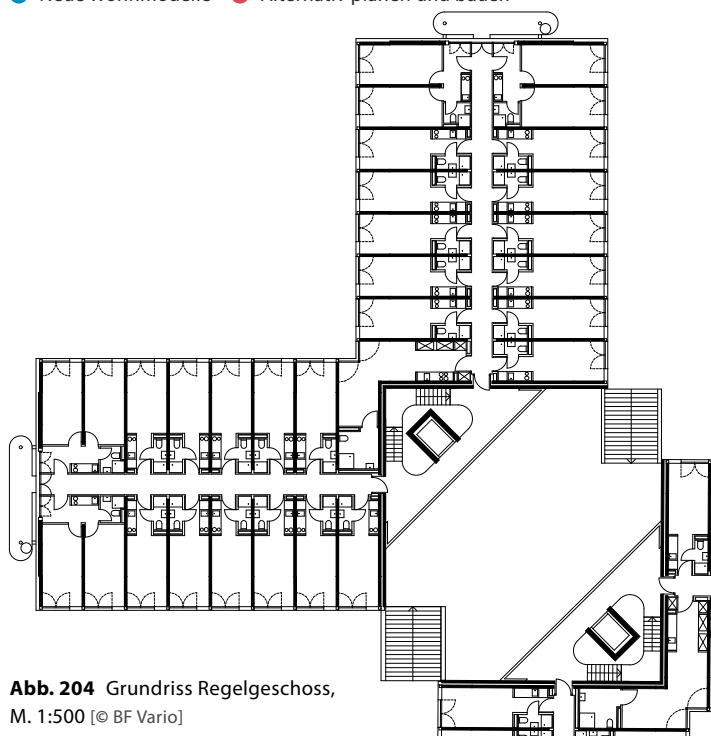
Grundriss Regelgeschoss, M. 1:500 [© BF Vario]
